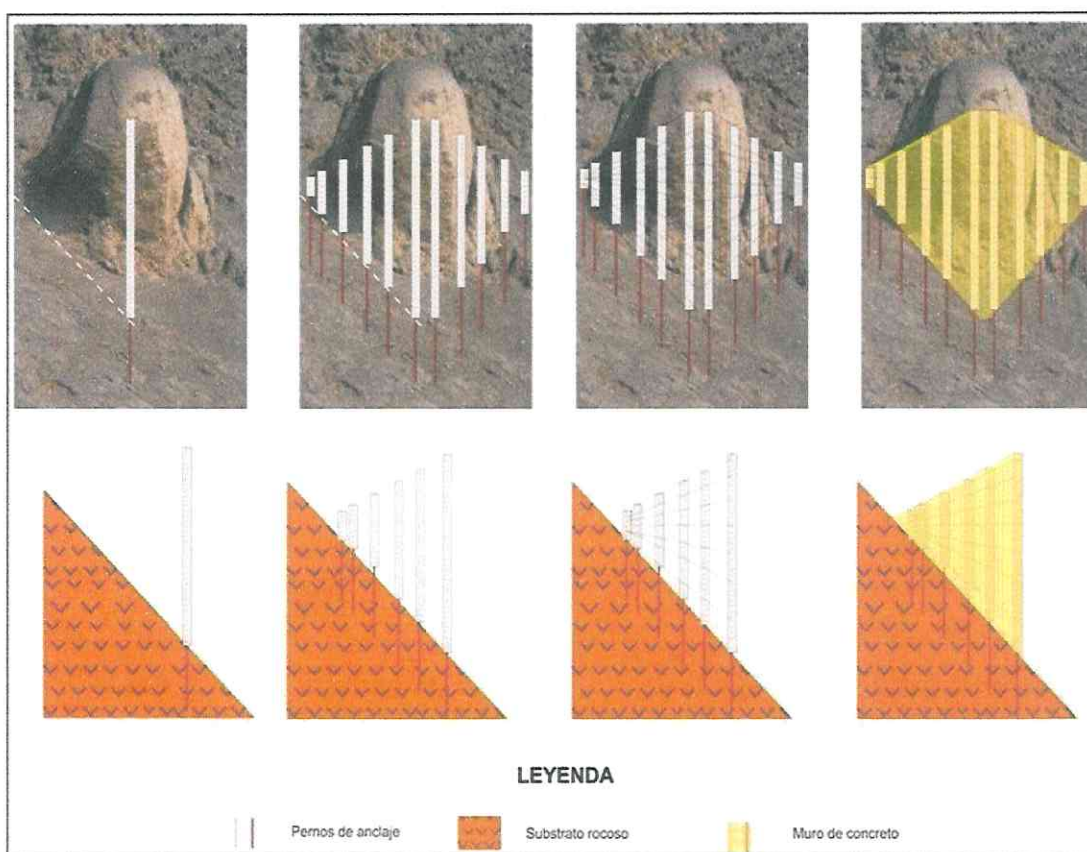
Muro en la base de un bloque a fin de proteger las viviendas
